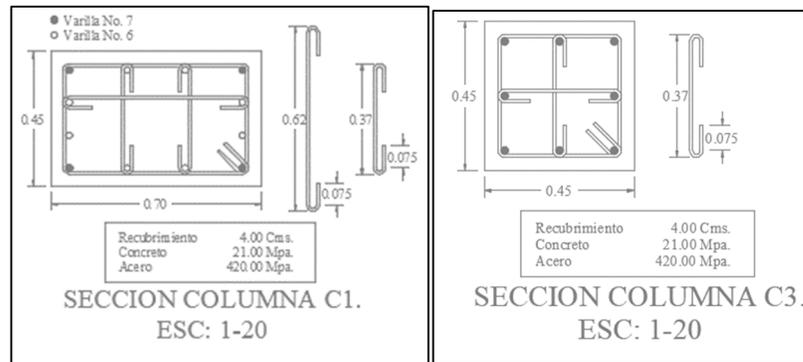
, Detalle de la sección de las columnas del bloque 2
